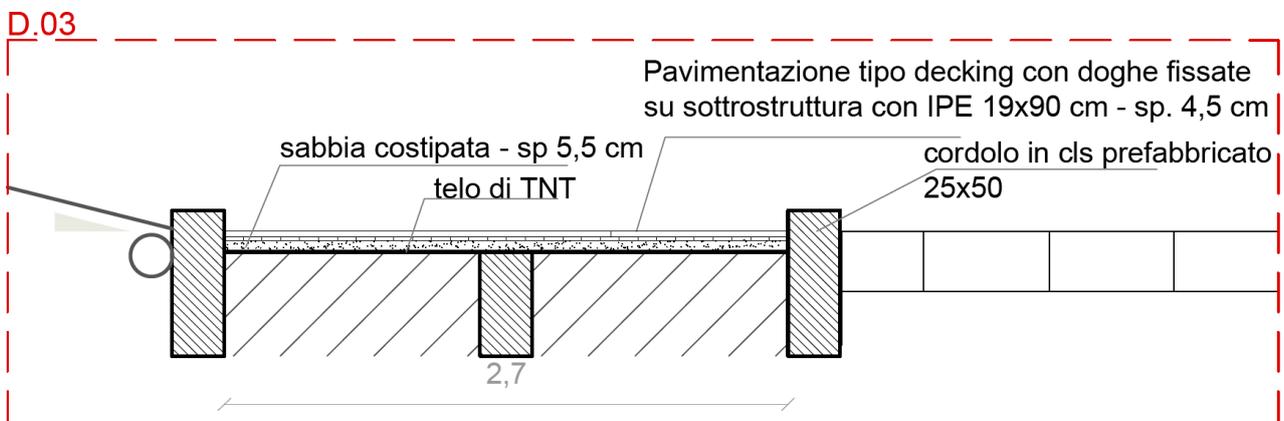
Dettaglio in sezione delle modalità di realizzazione della pavimentazione in doghe
